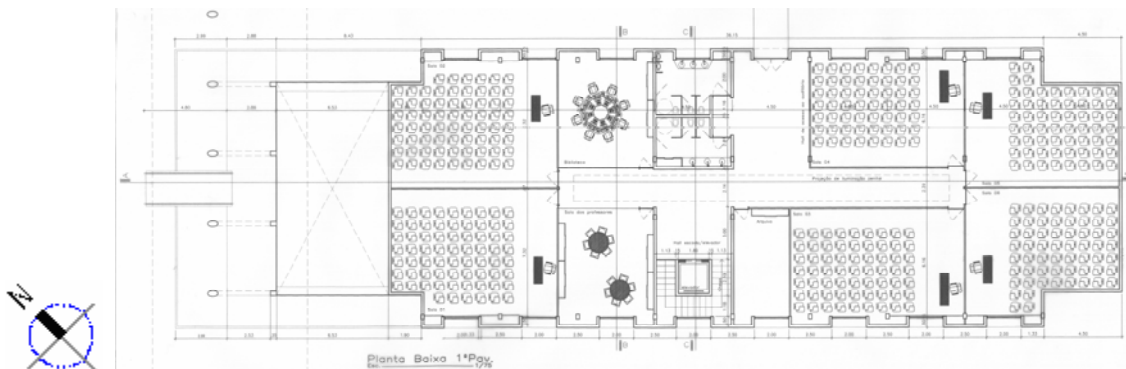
Planta baixa da Corregedoria de Justiça.
